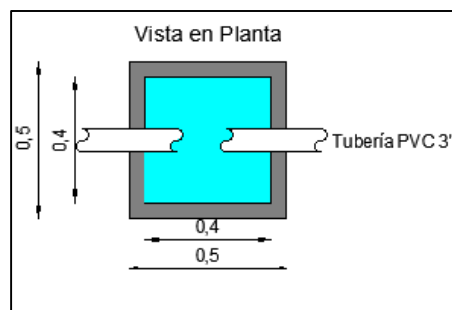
Vista en Planta – Volumen tanque de almacenamiento
